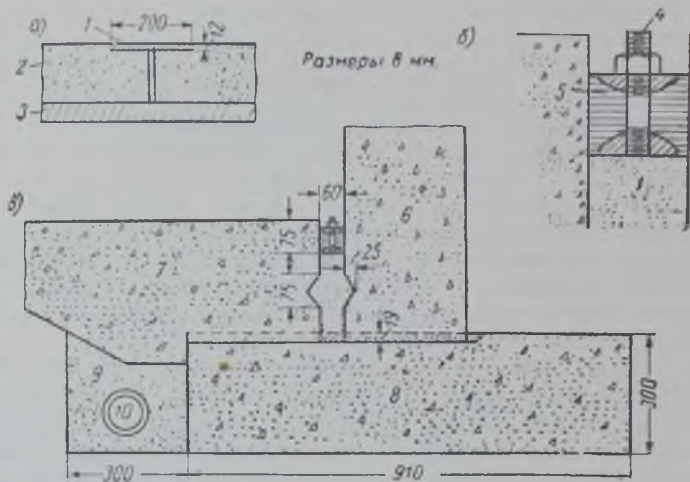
Эластичный шов между дном и стеной железобетонной водонапорной колонны
